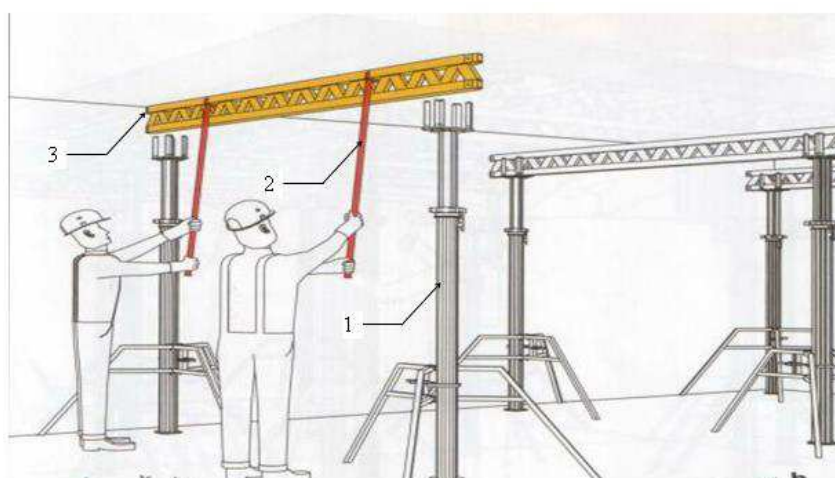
Монтаж продольных балок: 1-основная стойка с треногой и унивилкой; 2-монтажная штанга; 3-монтируемая продольная балка
